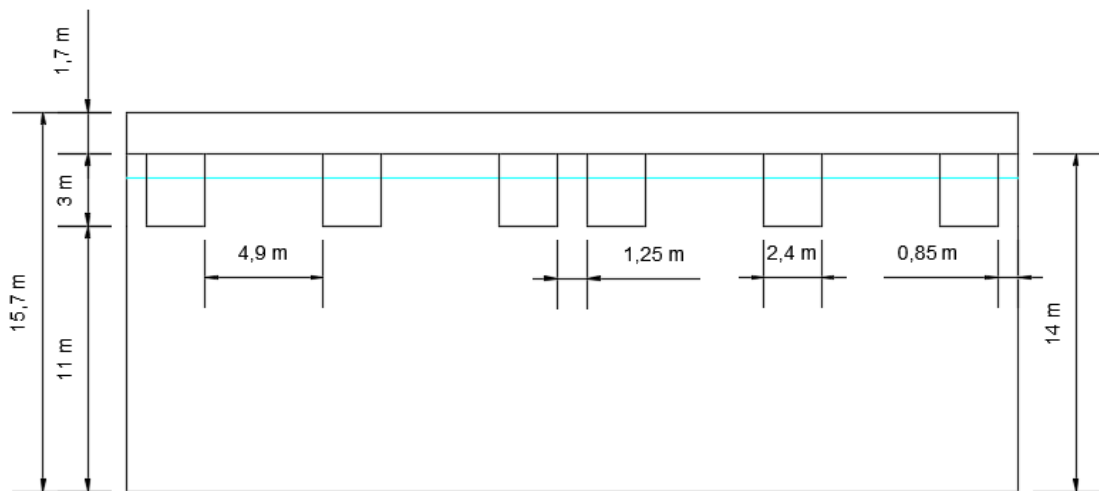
Geometría del cajón antirreflejante en alzado para las ondas de infragravedad. Fuente: Propia
